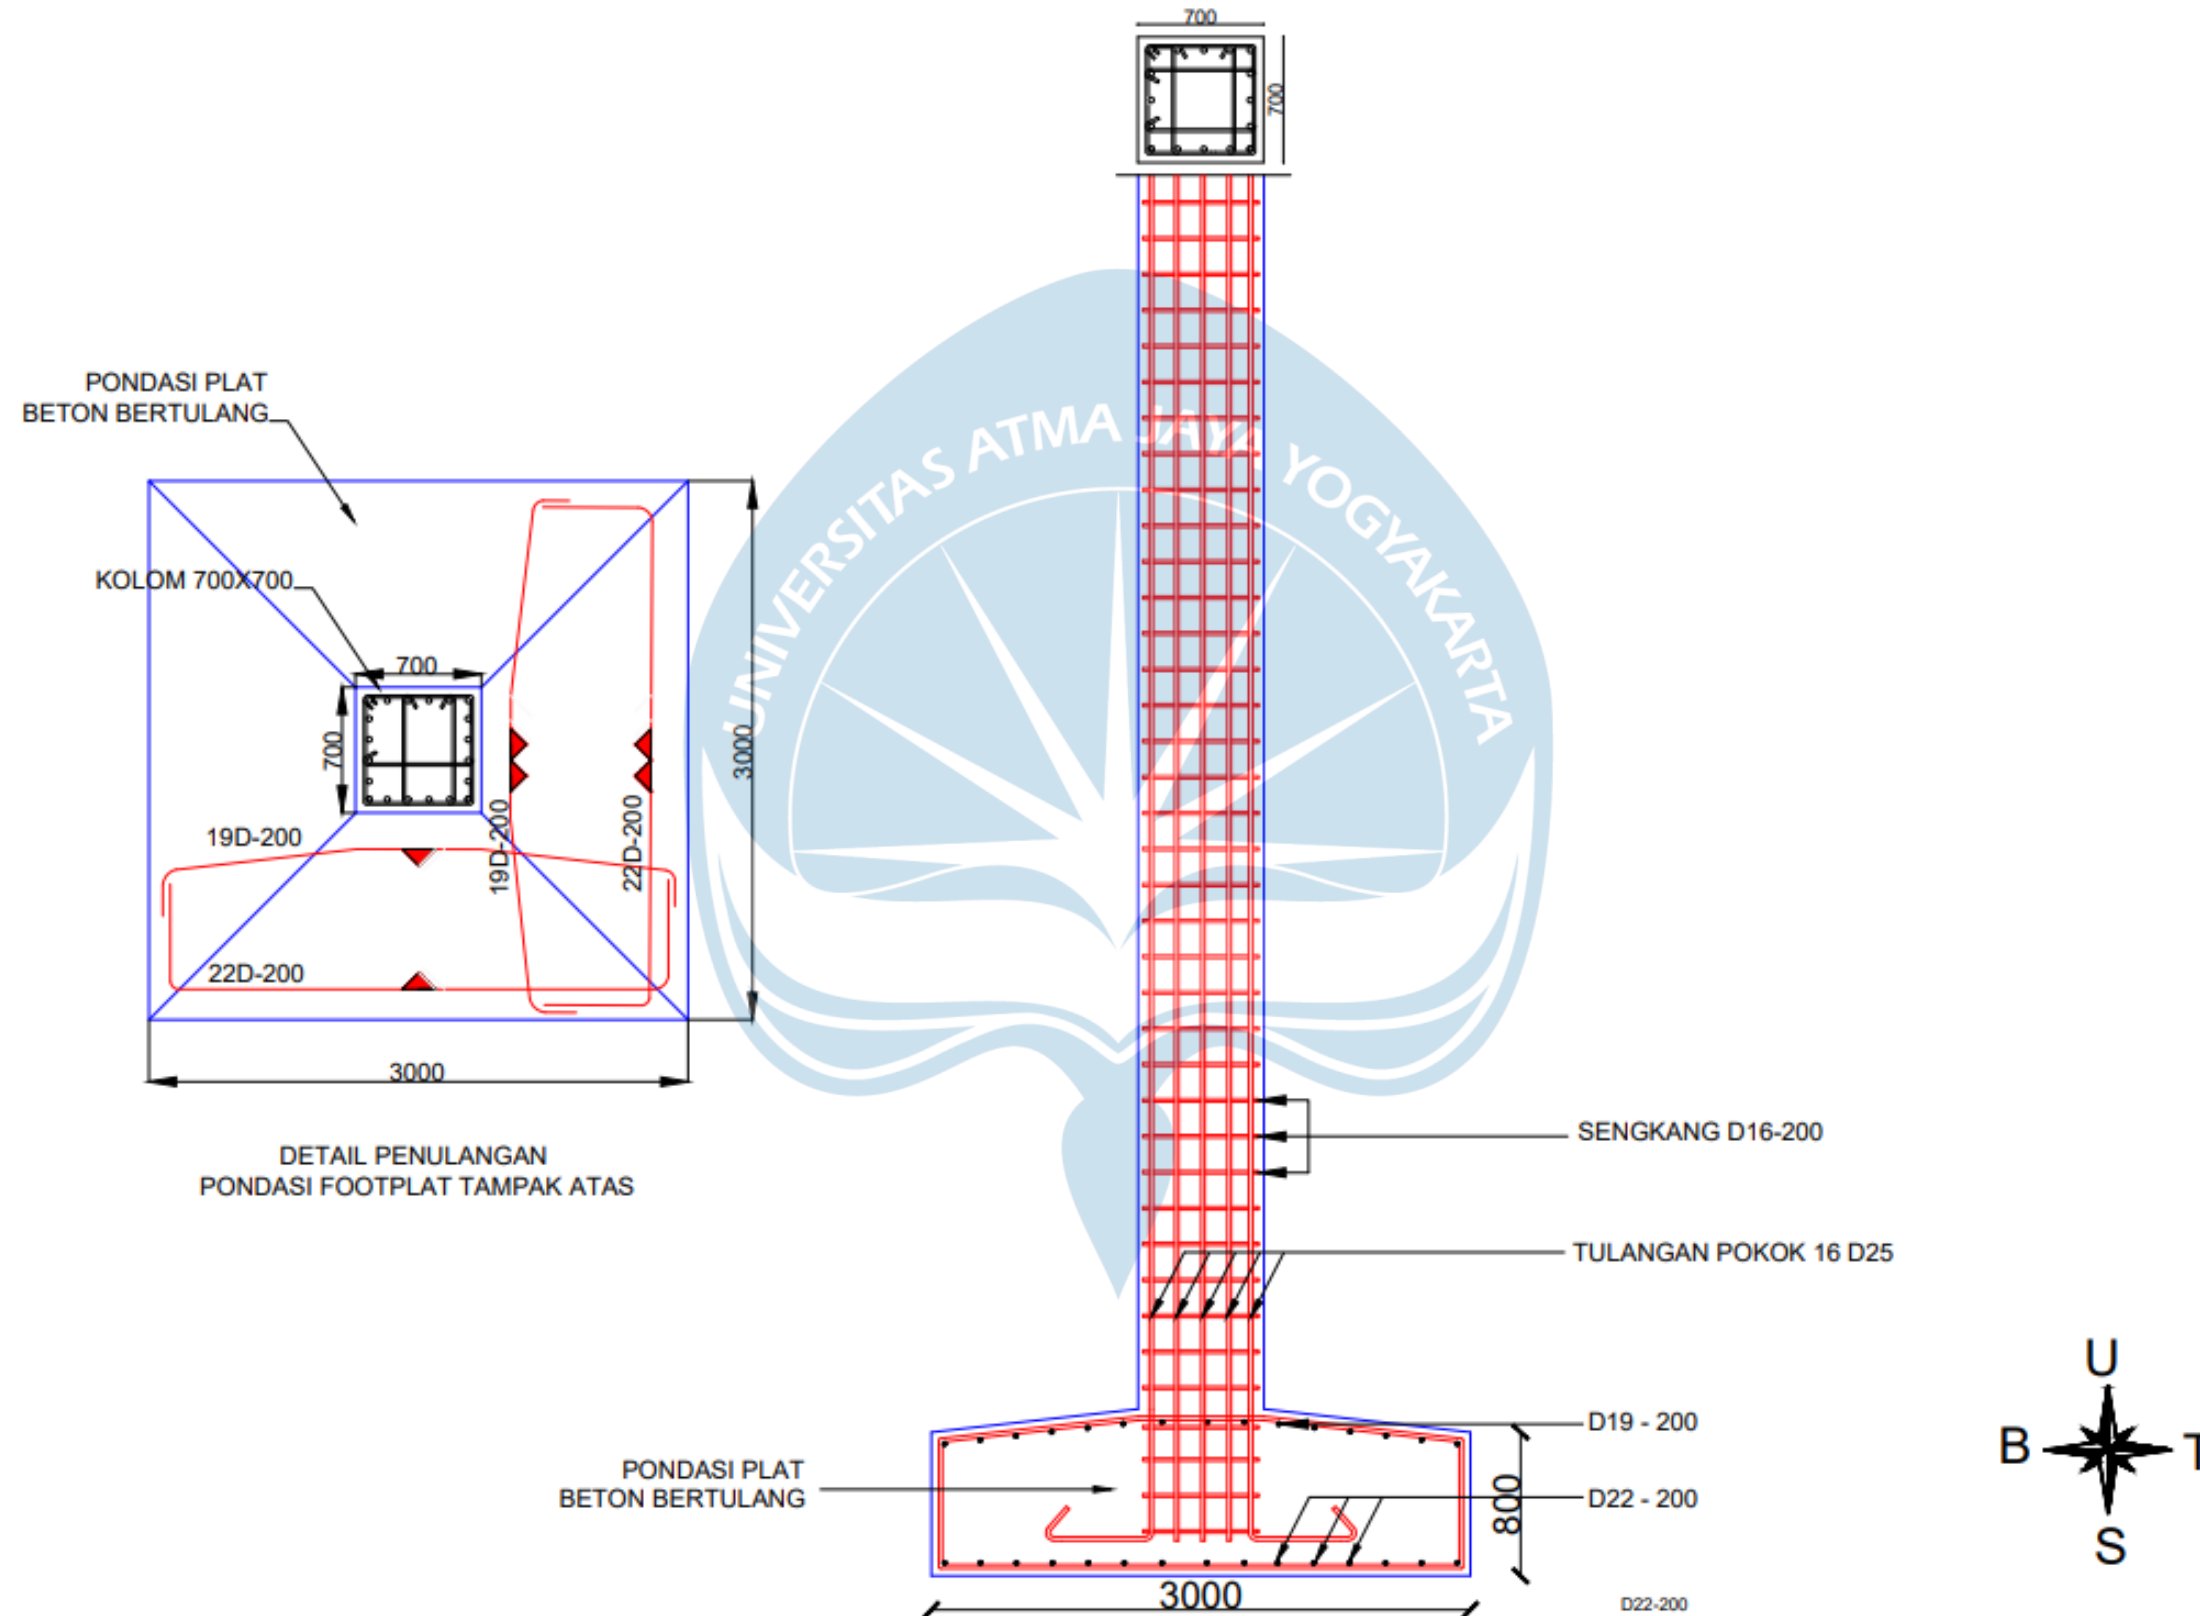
DETAIL TULANGAN FONDASI FOOTPLAT 5X5
